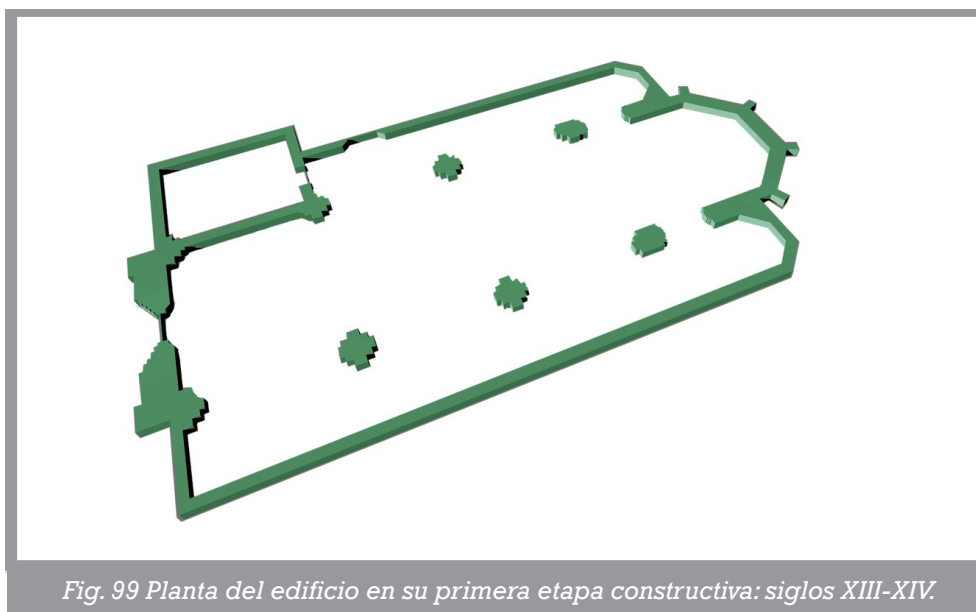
Planta del edificio en su primera etapa constructiva: siglos XIII-XIV.
